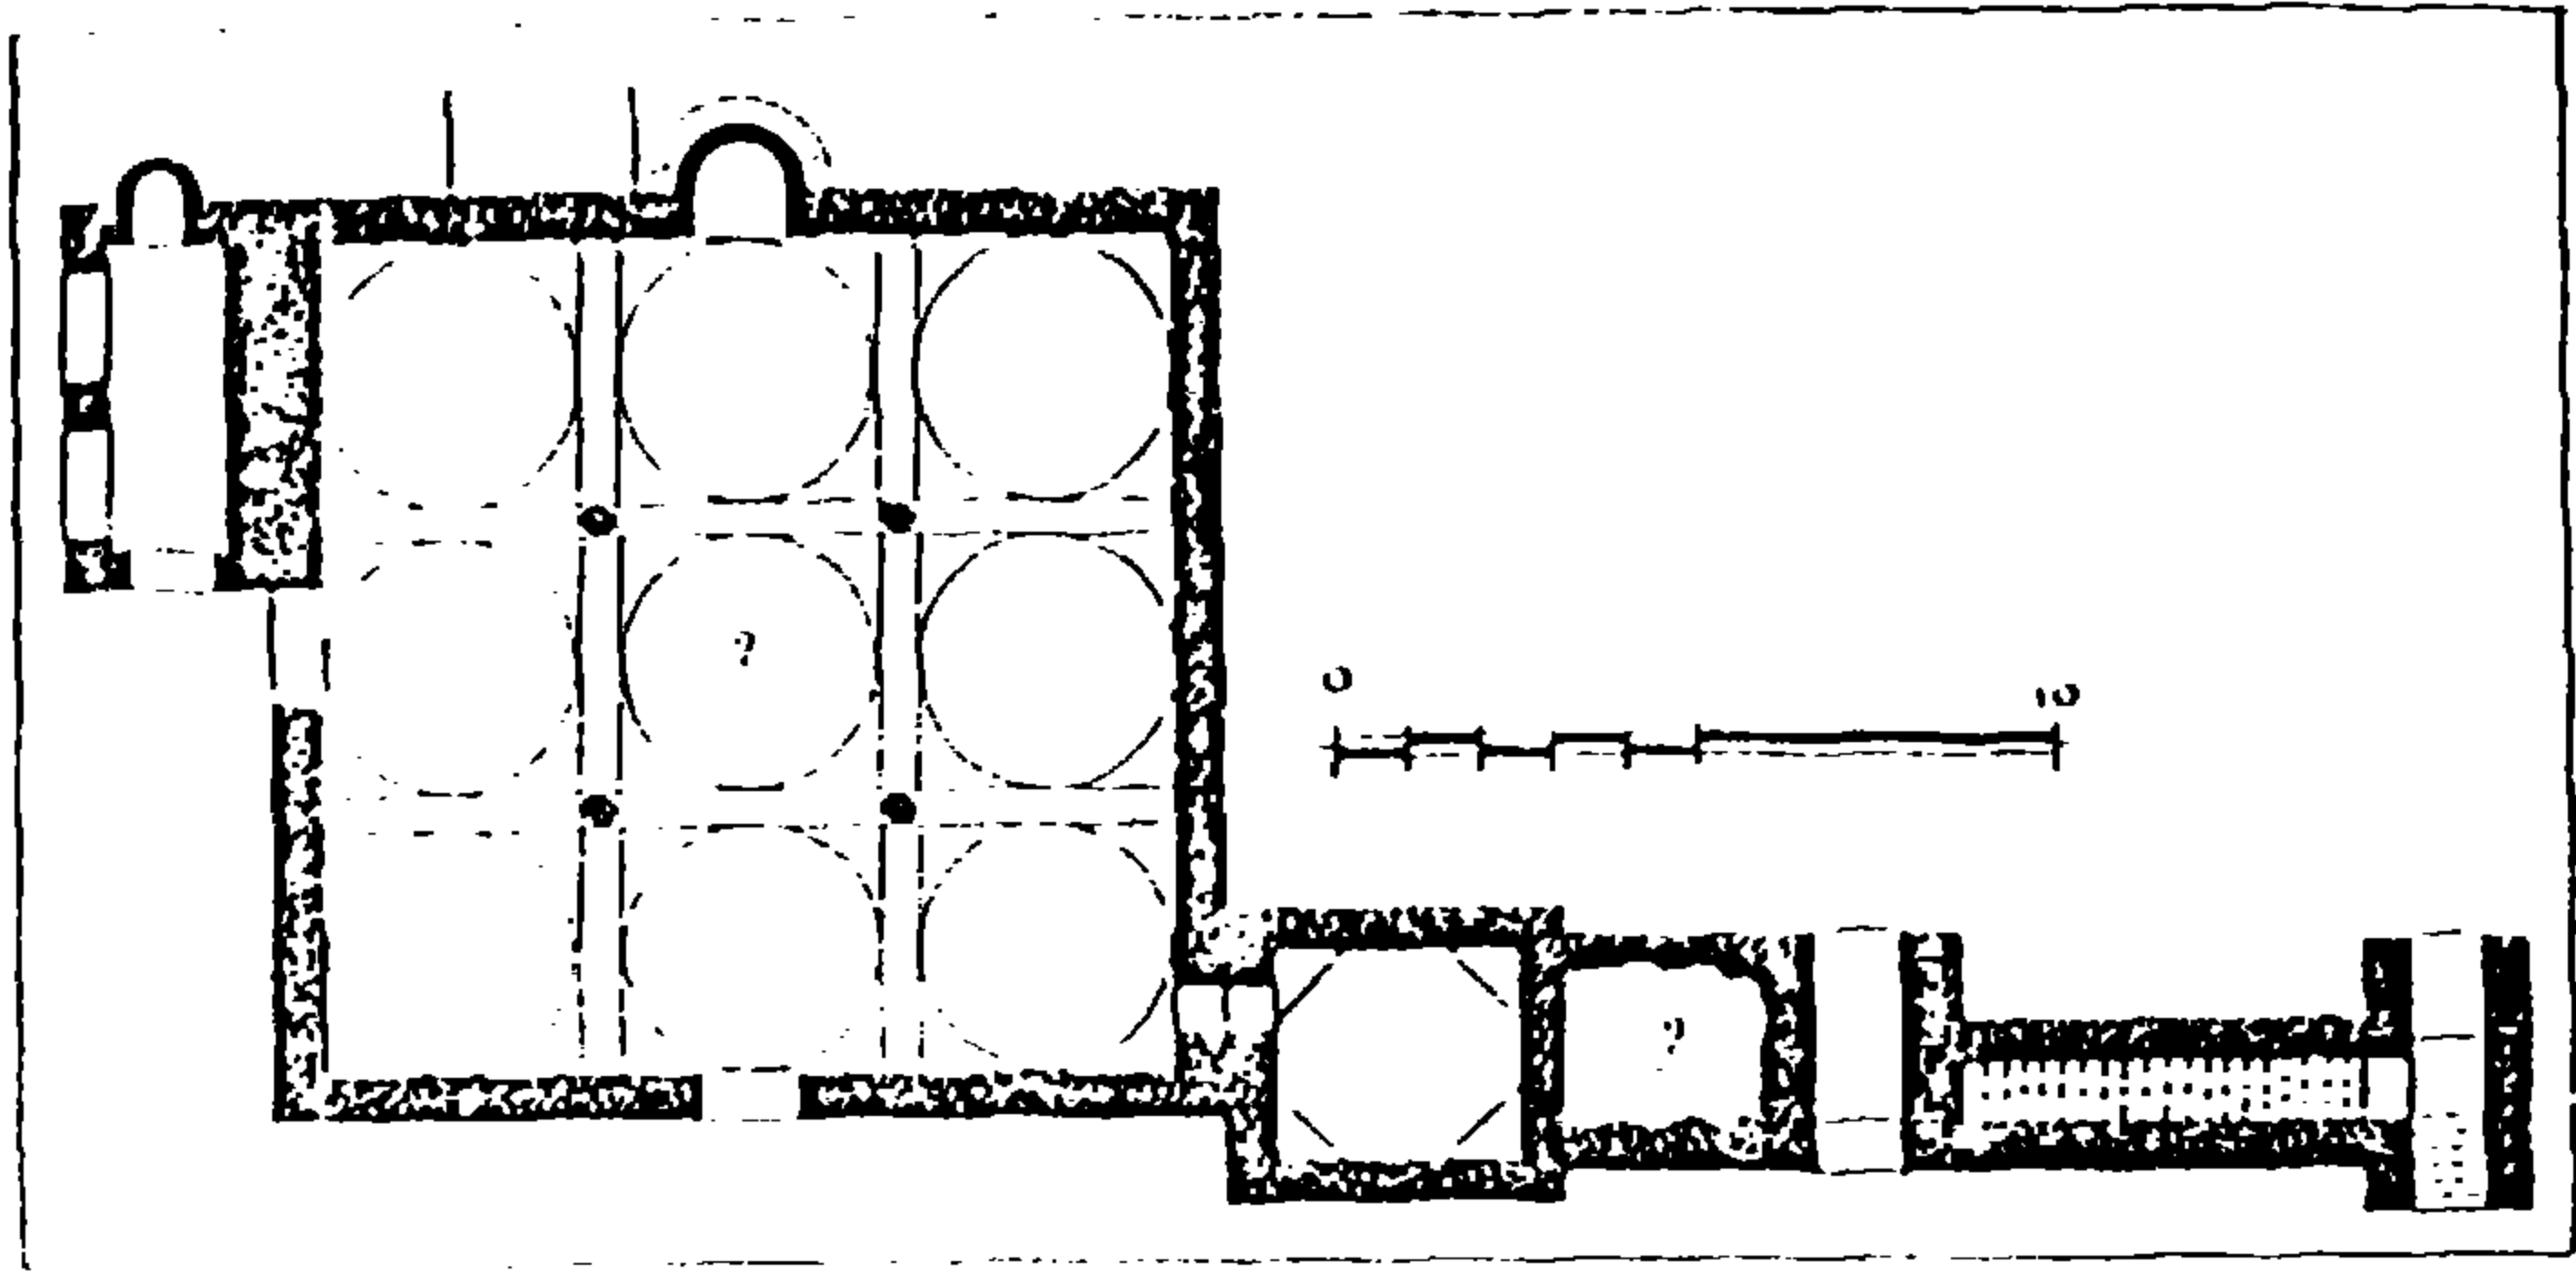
المسقط الأفقى لجامع محمد أبو الذهب
